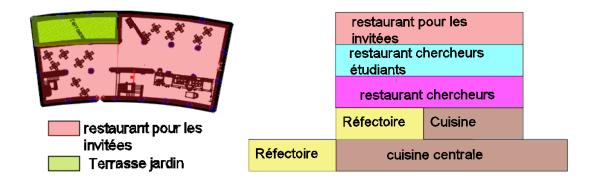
Plan de 3 eme étage Figure 71 : Coupe schématique
